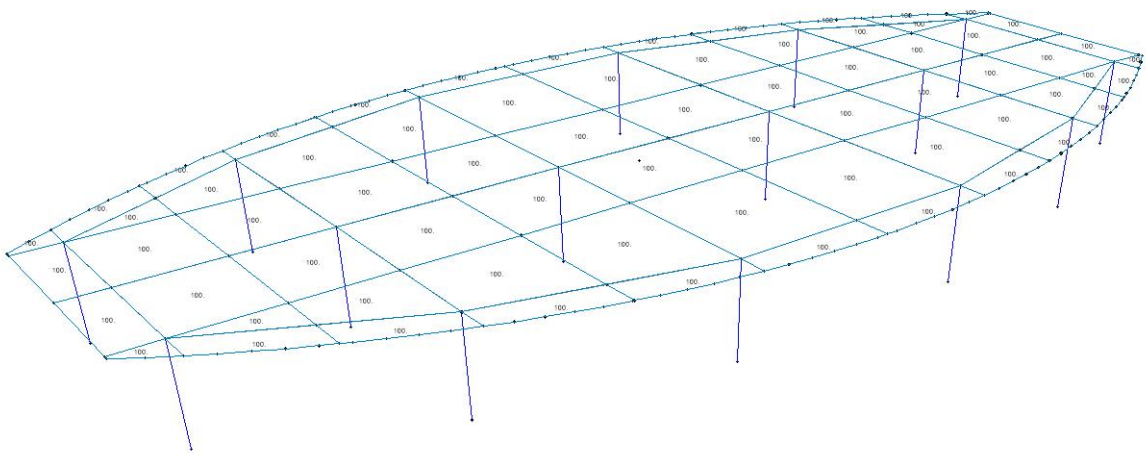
Input Beban Mati Utilitas Bangunan (ME)
